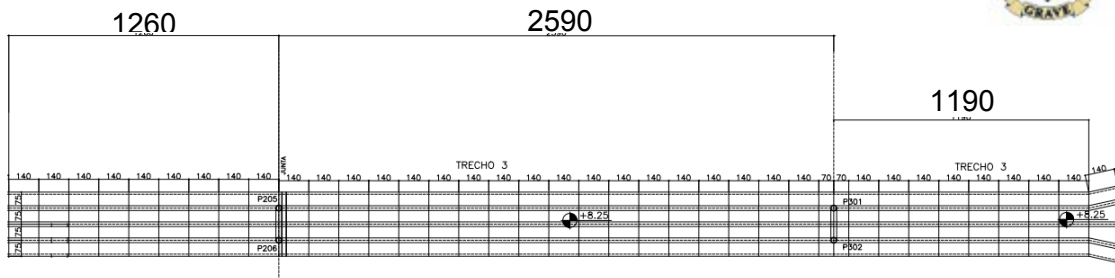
Passarela Terminal Centro Olímpico: Vista superior Trecho 3 (dimensões em cm)
